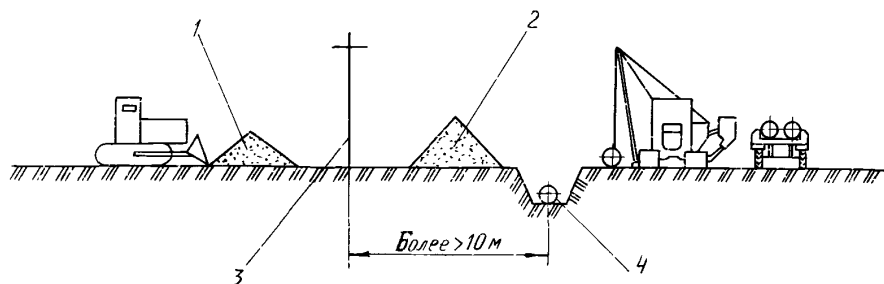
Схема расположения при совмещенном строительстве трубопровода и вдольтрассовой ОЛП 6-10 кВ;
